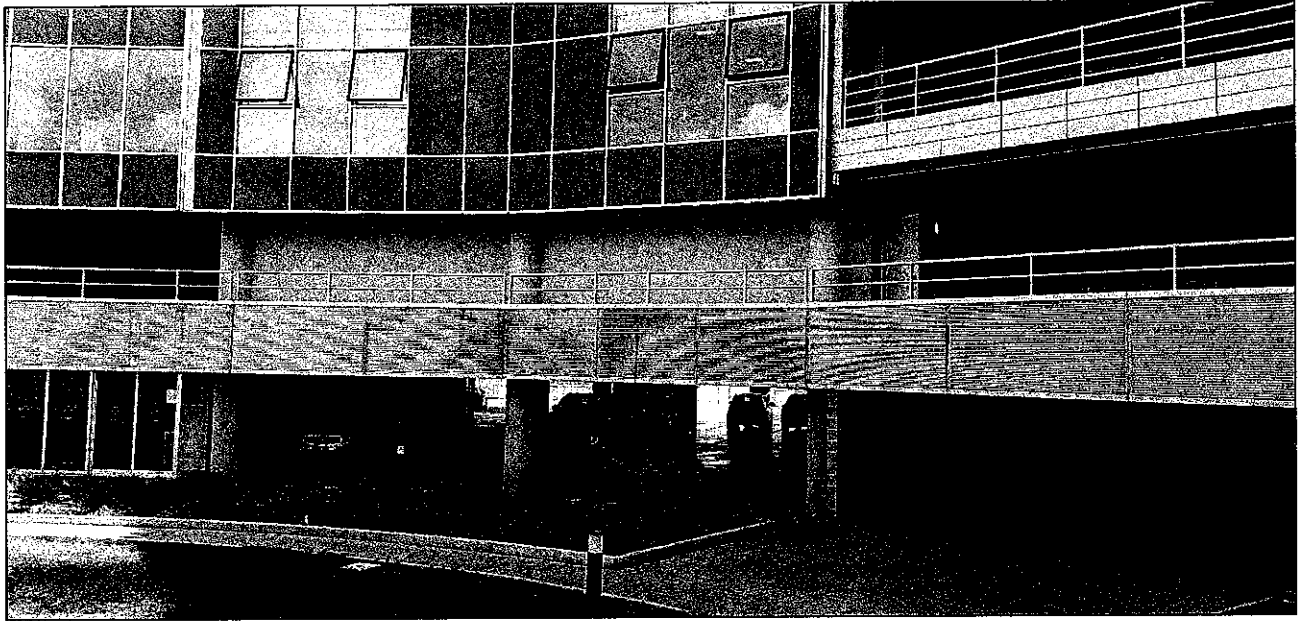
Fabbricato "L4B" - Prospetto sulla piazza centrale
